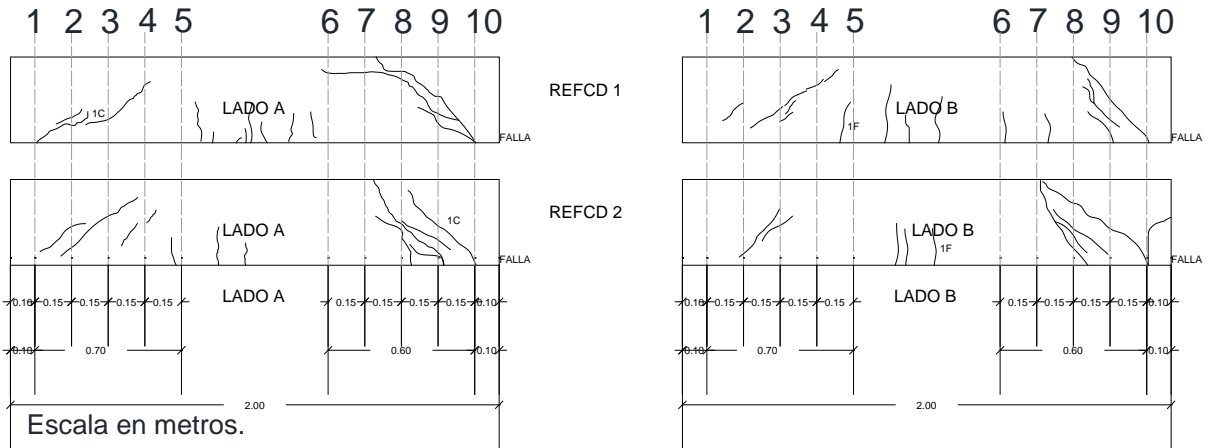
Patrón de agrietamiento en ambas caras de las vigas de control con deterioro REFCD ensayadas a flexión.
